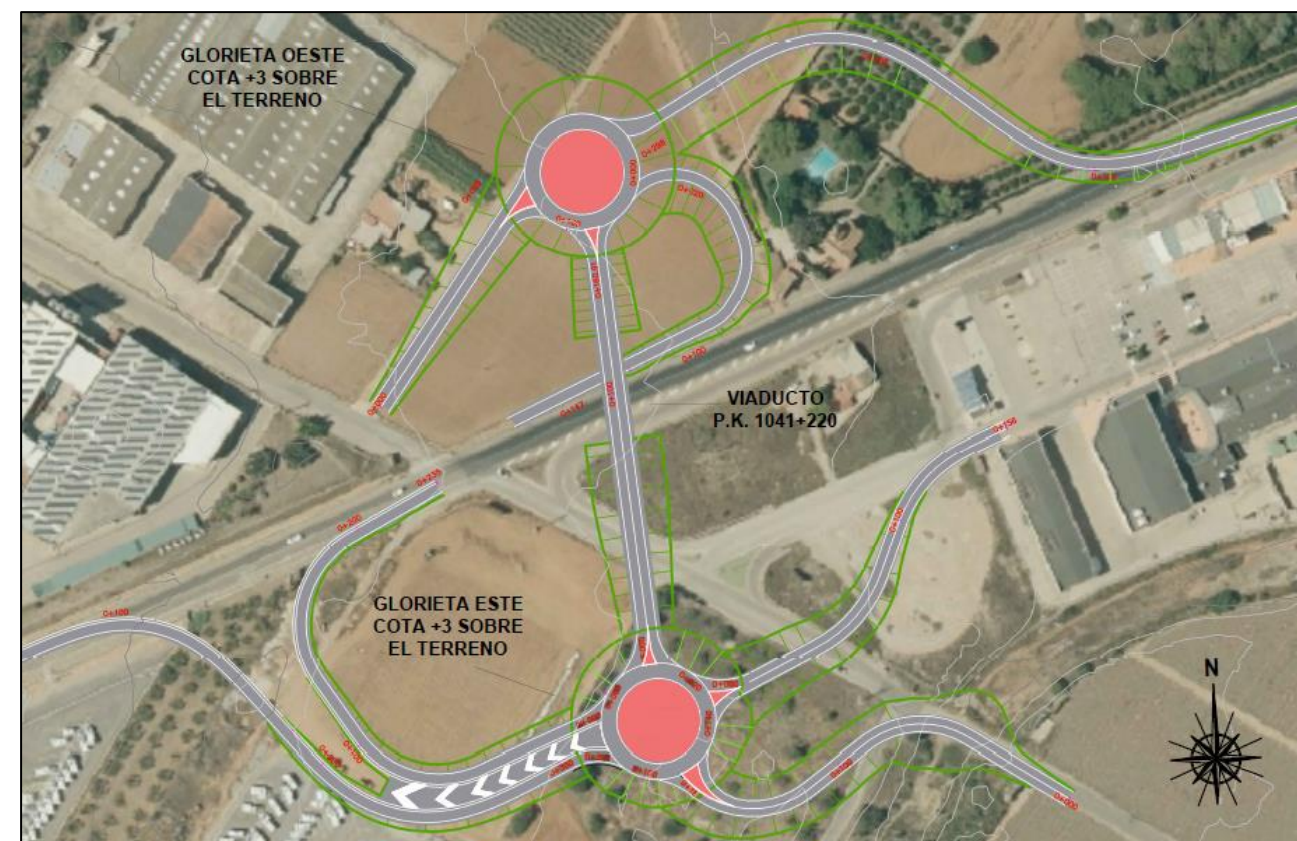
Imagen en planta con la solución proyectada. Fuente: elaboración propia.
